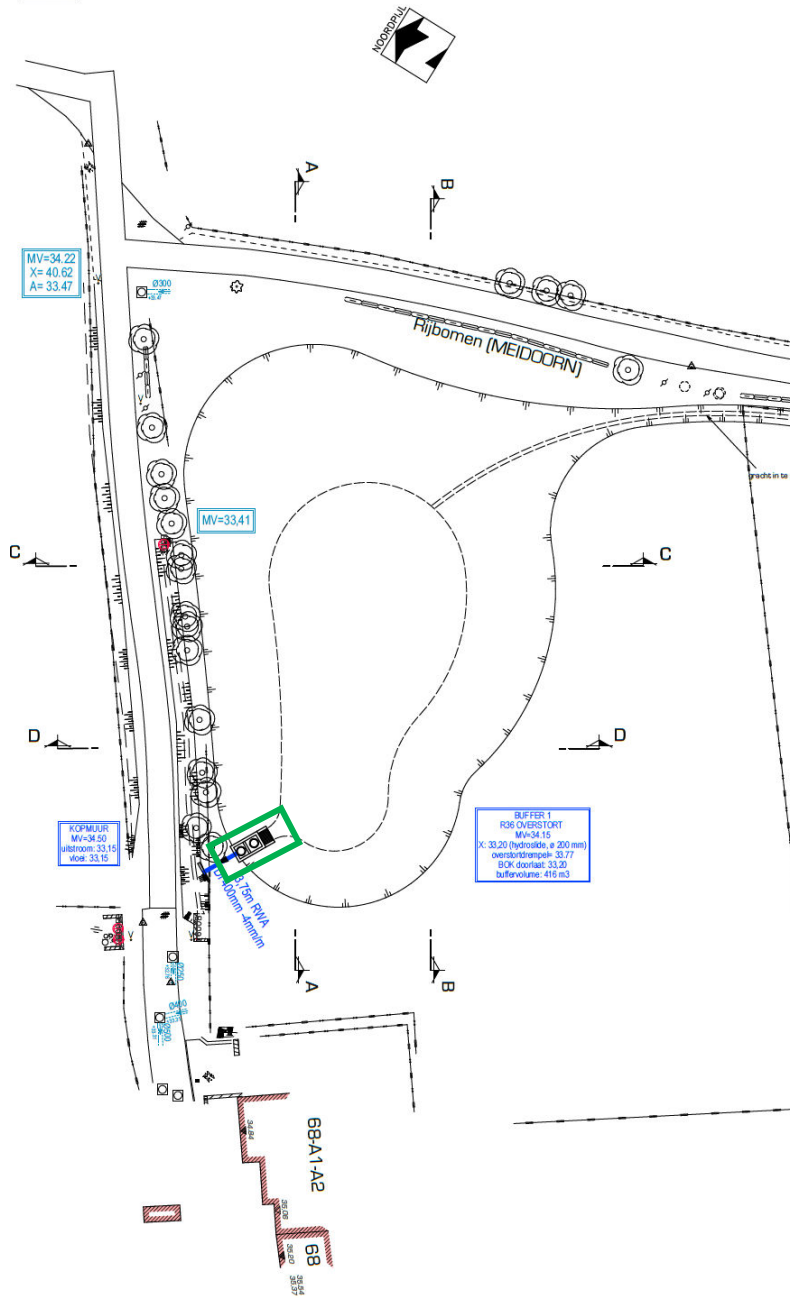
Plan van de ontworpen toestand (bron: Gemeente Haaltert, zie bijlage 1)
